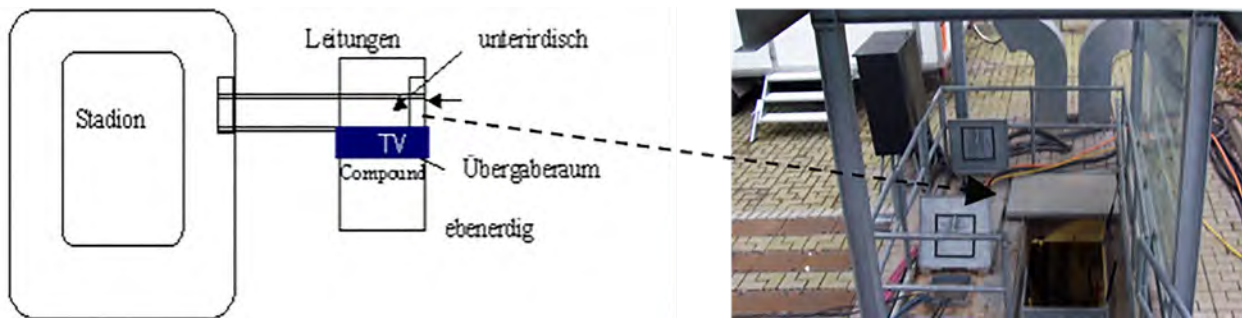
Schematisch Darstellung / Foto (Stadion Köln – Medienanschluss außerhalb)
